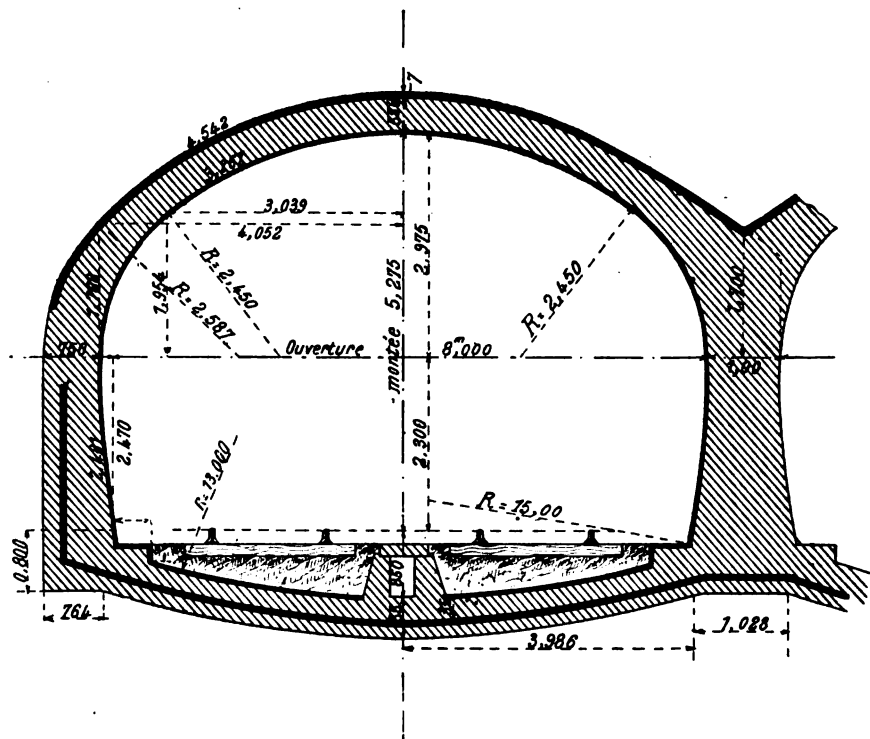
Section transversale (2 tunnels de 8 m.).
